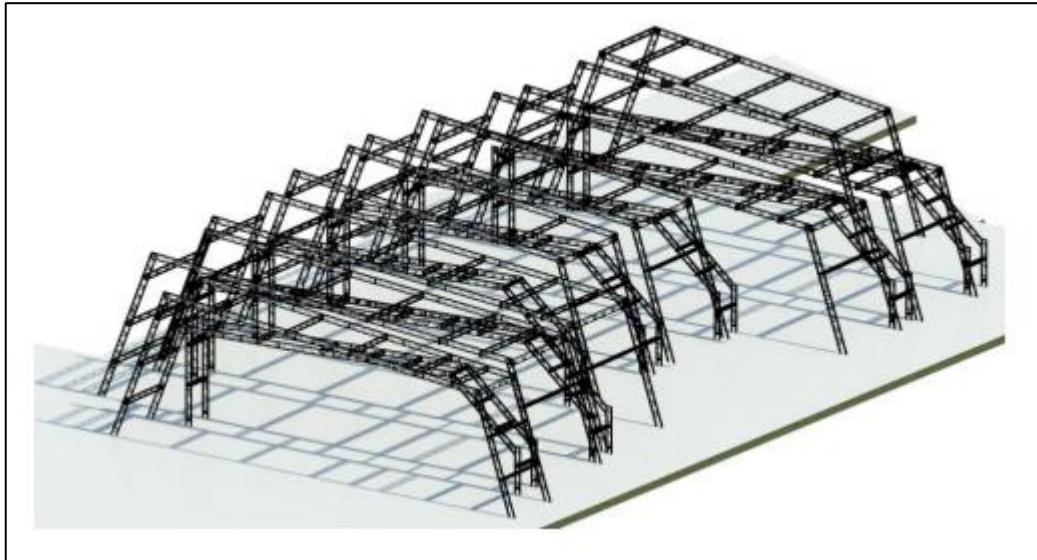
; Envoltente estructural; Fuente: Josué Maruri Lovato
